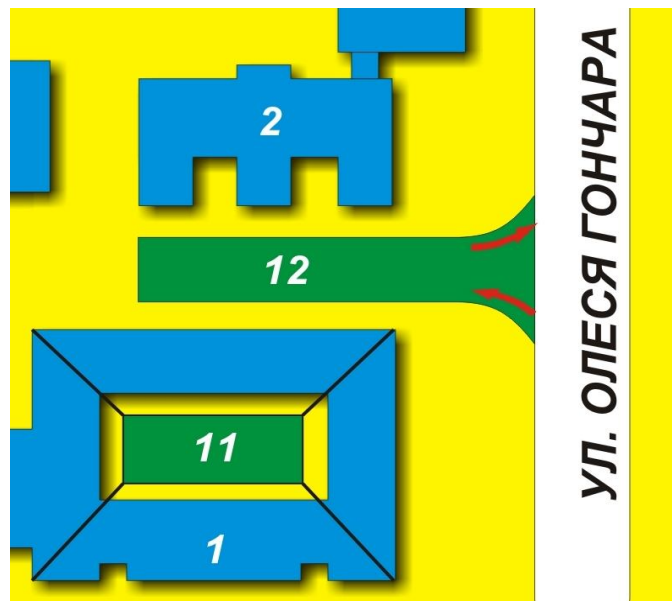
Схема расположения корпусов НГУ и подземной стоянки для автомобилей
